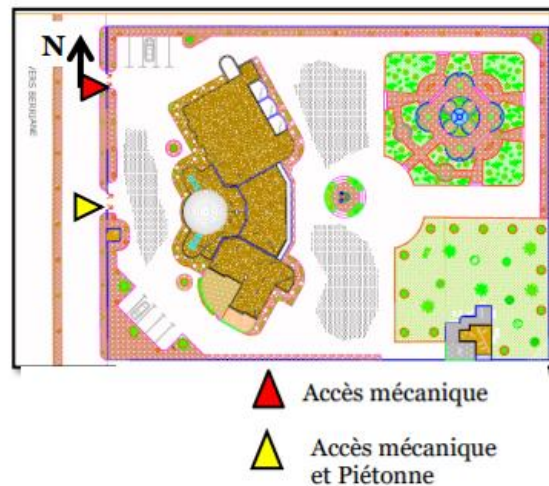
plan de masse du projet Source : Dossier d'architecture du projet
